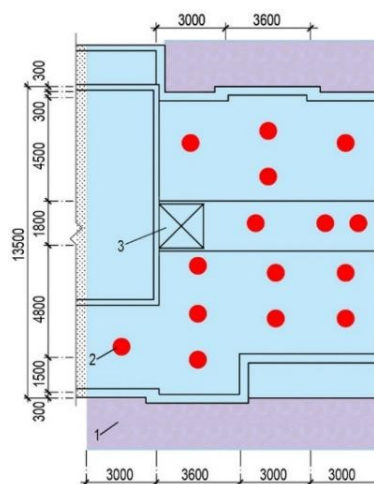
Схема плана кровли базового объекта (слева); измененной показана правая часть торцевой секции: 1 – кровля над приставными лоджиями; 2 – вертикальный световод; 3 – вентиляционная шахта (труба)
